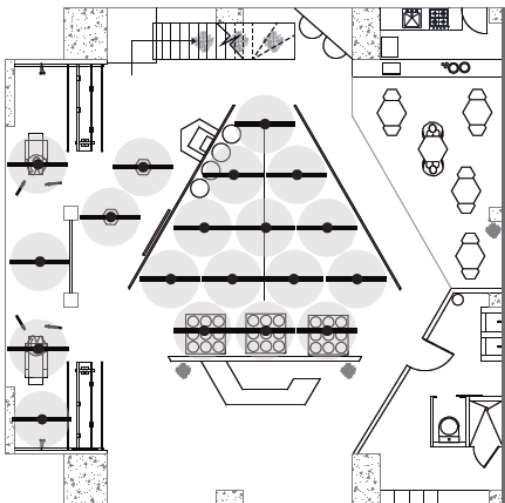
Detalle constructivo Módulo de meditación. Autoría propia.
